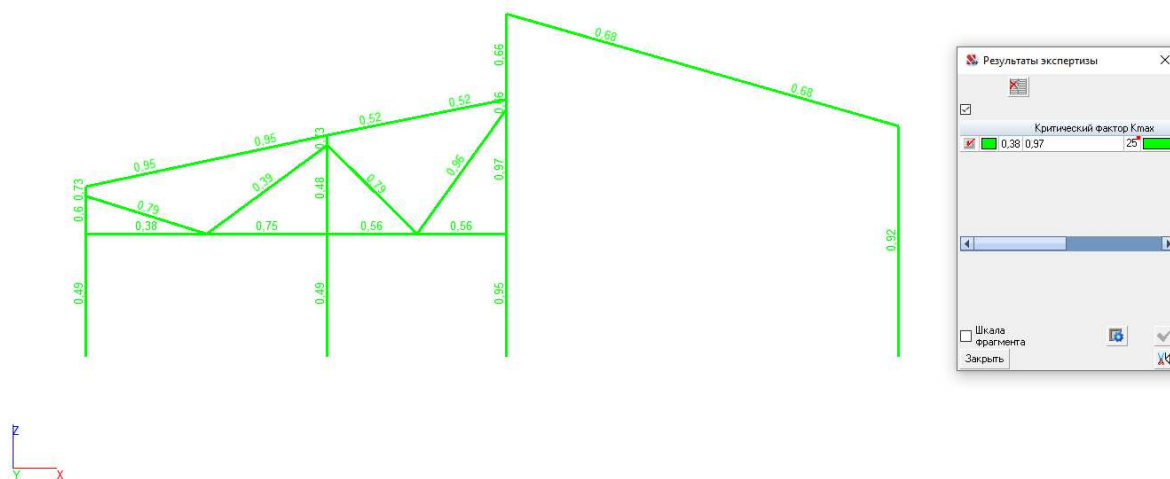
Результаты проверки подбора сечений ПК SCAD
